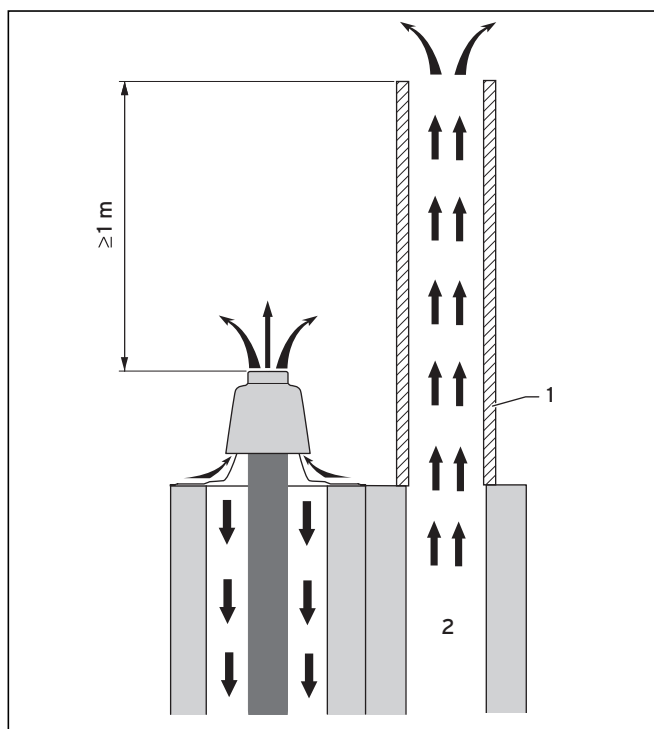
Высота дымовой трубы над выпускным газопроводом из ПП - с забором воздуха не из помещения
